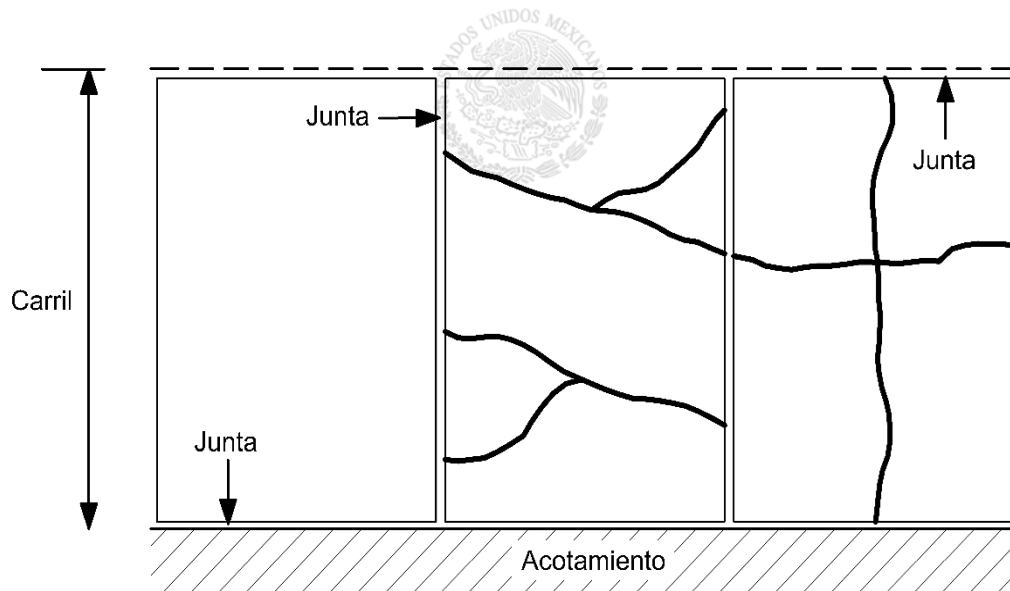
Esquema del deterioro "losa dividida" (vista en planta)
